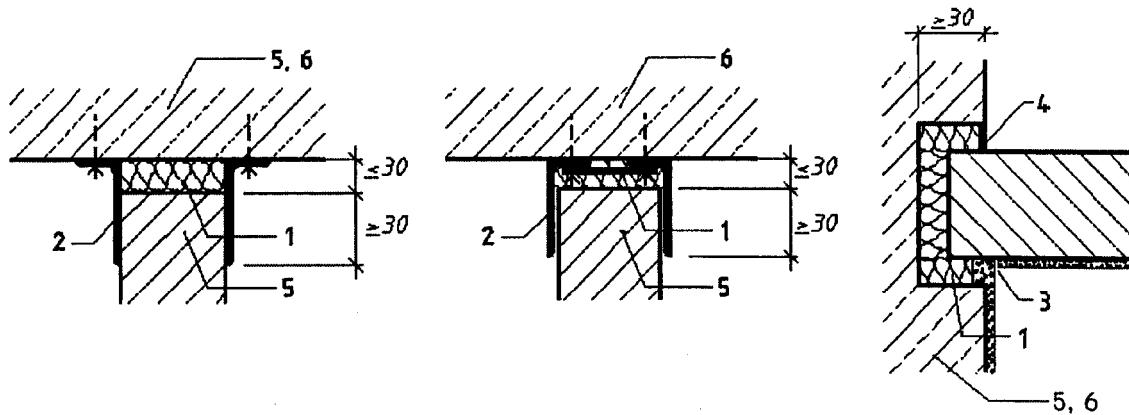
З'єднання стіни з несучими стінами з кам'яної кладки
